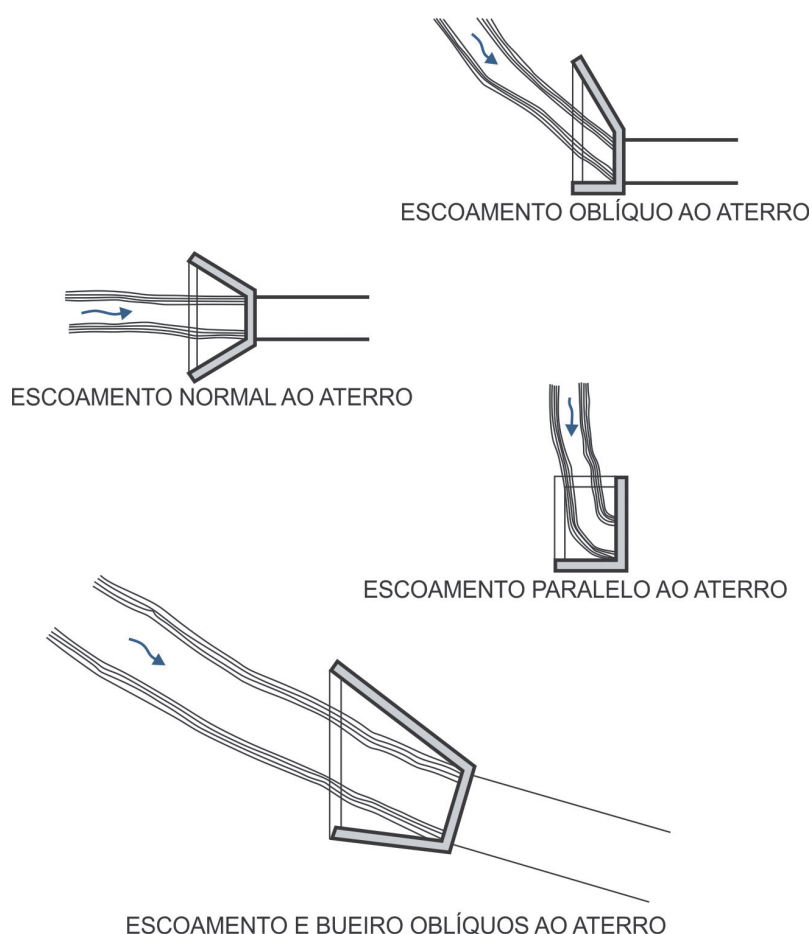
Configurações típicas de muro de testa e de muro de ala
